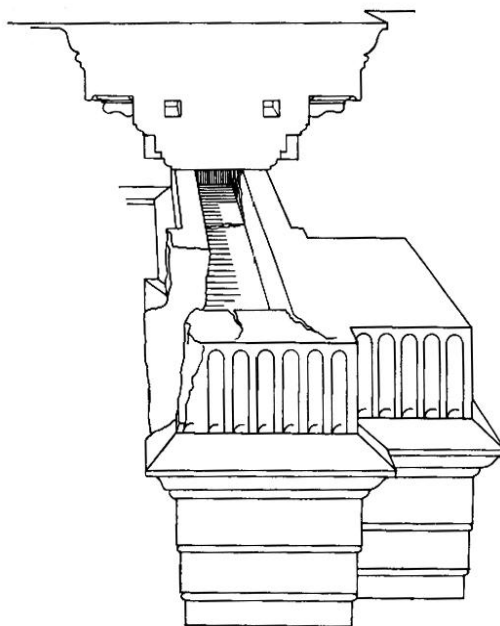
Logement d'une poutre de béton dans l'architrave.
